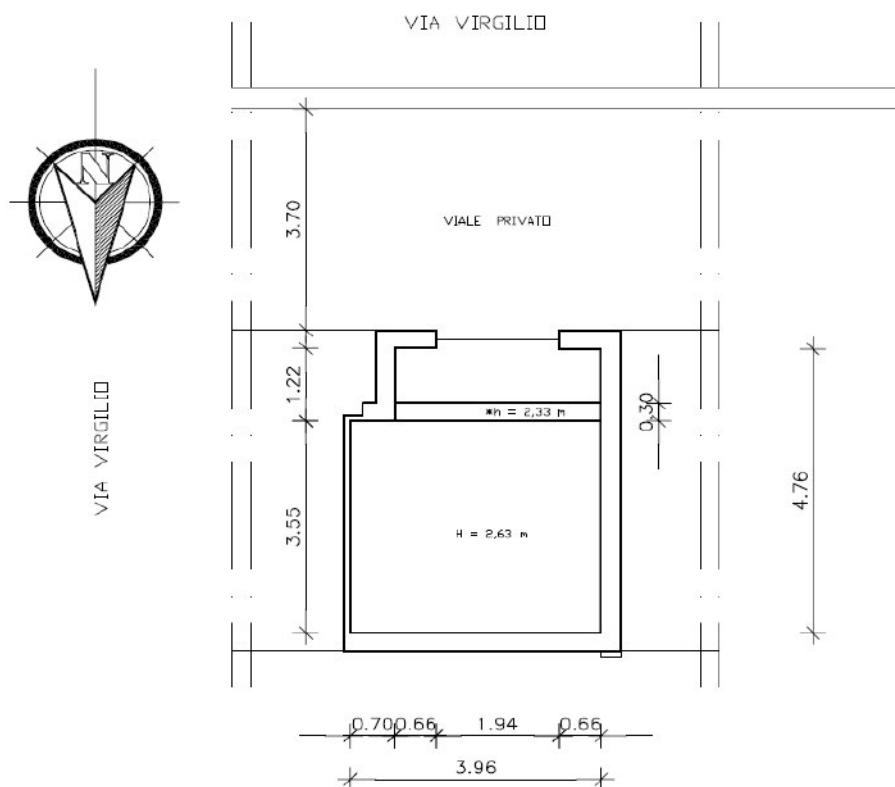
STATO DI FATTO - PIANTA IMMOBILE PIANO TERRA OGGETTO DI PIGNORAMENTO SOPRALLUOGO DEL 04/11/2021
